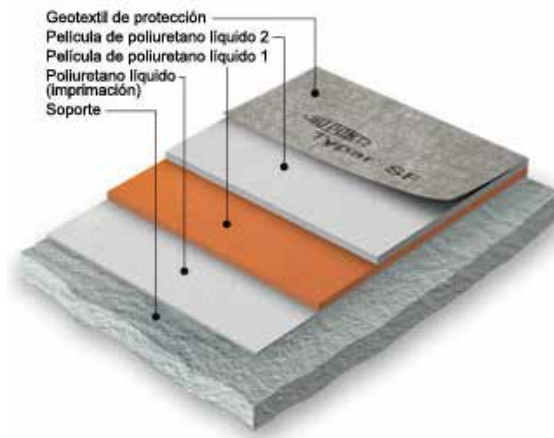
Impermeabilización de techo. <http://www.nortena.es/pl3.html> (2017).
